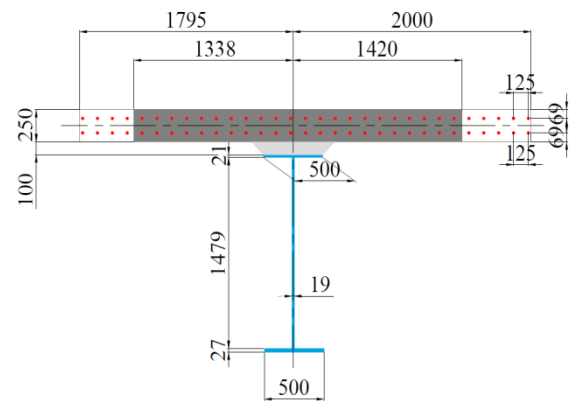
負曲げ域断面(A-C, D-B 間)(単位: mm)
